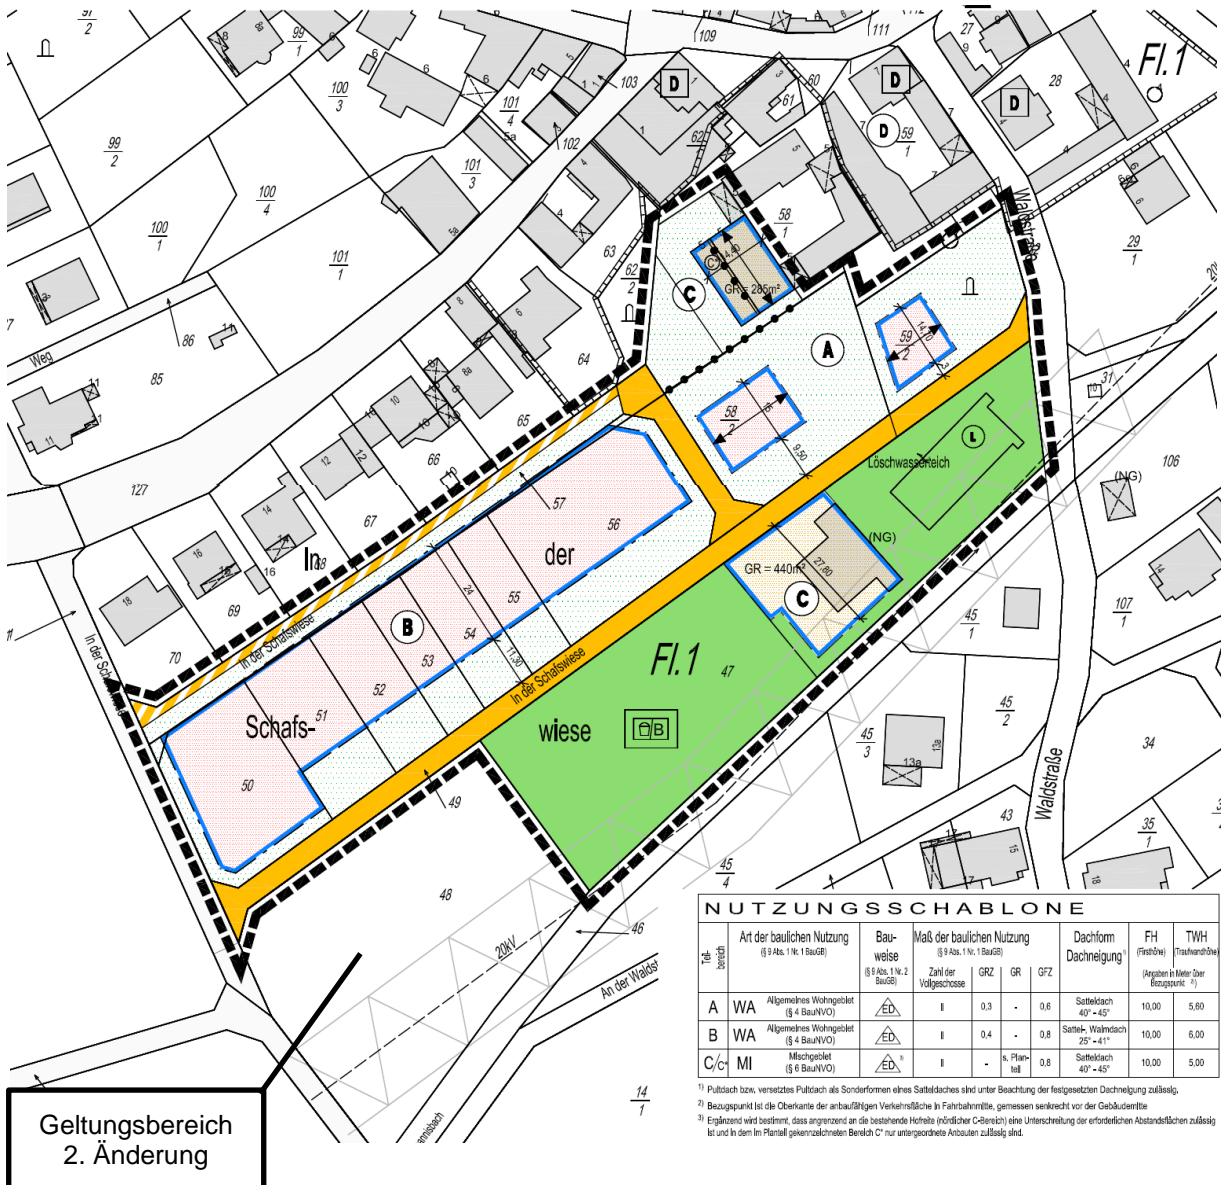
Auszug aus dem Planbild zum Ursprungsplan bzw. 1. Änderung des Bebauungsplanes
